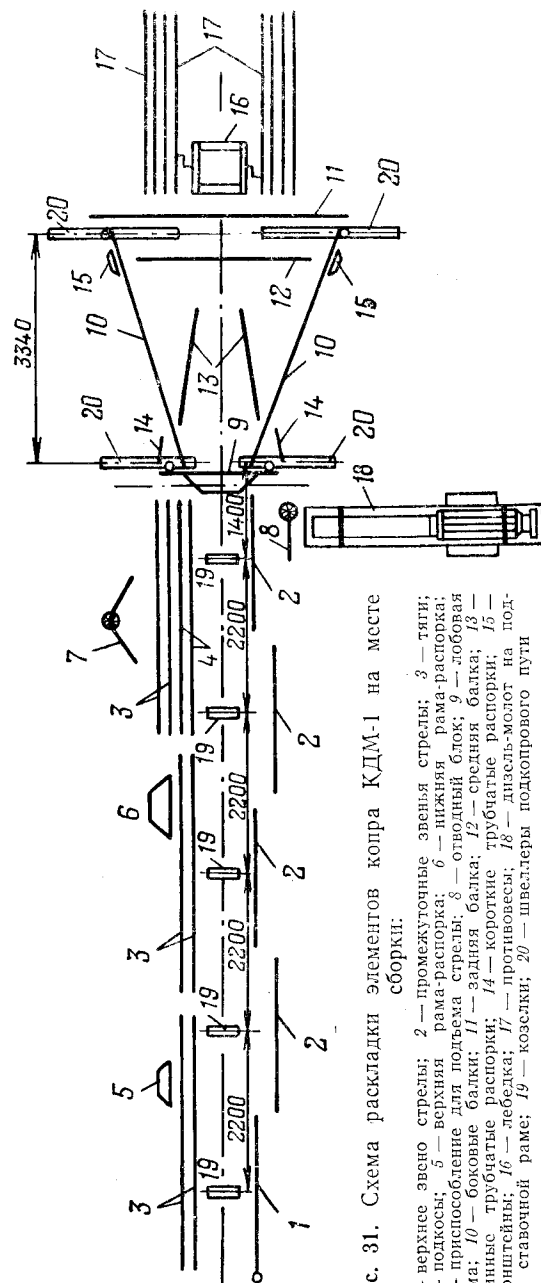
Схема раскладки элементов копра КДМ-1 на месте сборки.
